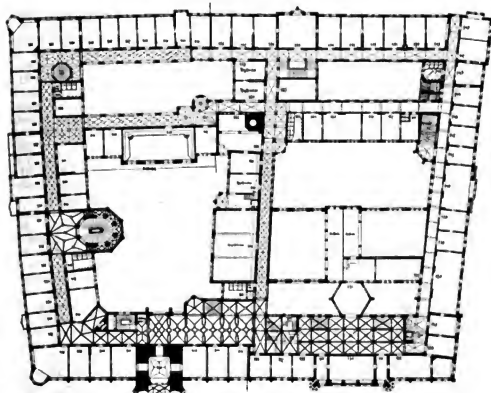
Grundriss vom III. Obergeschoss. — Masstab 1 : 800.
